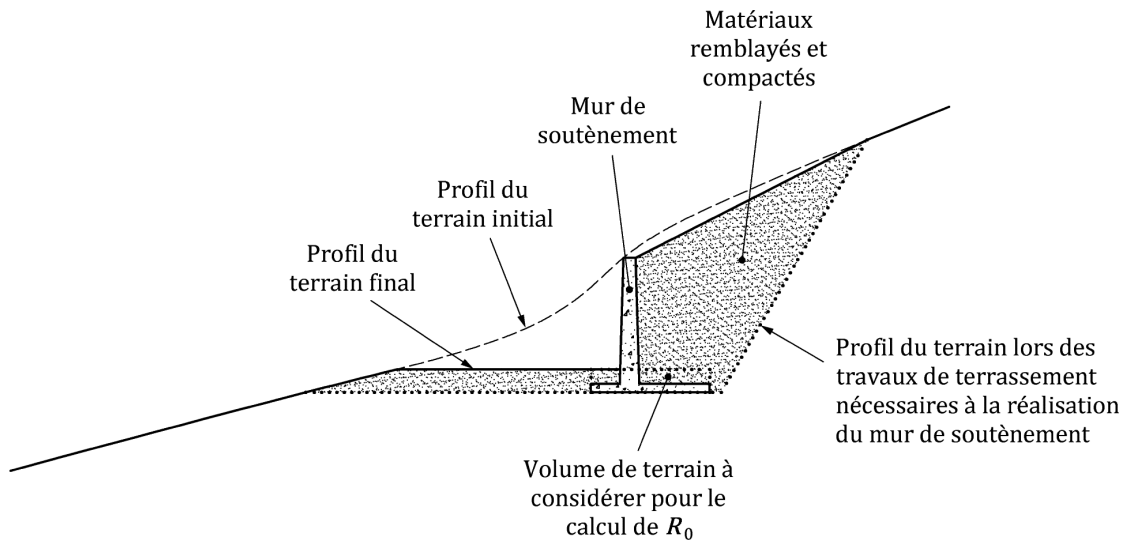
Exemple de calcul de R_0 dans le cas d'un mur de soutènement
